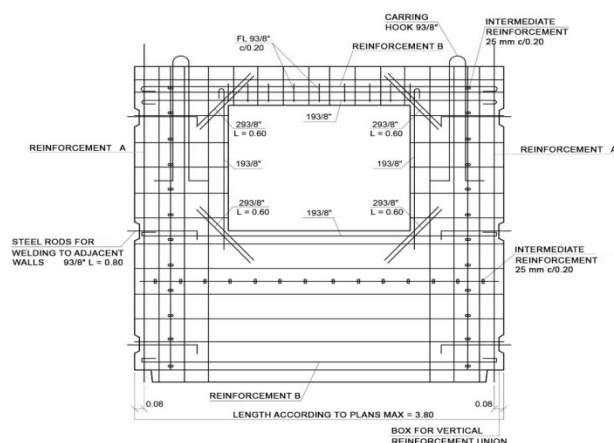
Armado de los paneles prefabricados de hormigón utilizados en SAYAB (Proyecto de Luis de Garrido)
